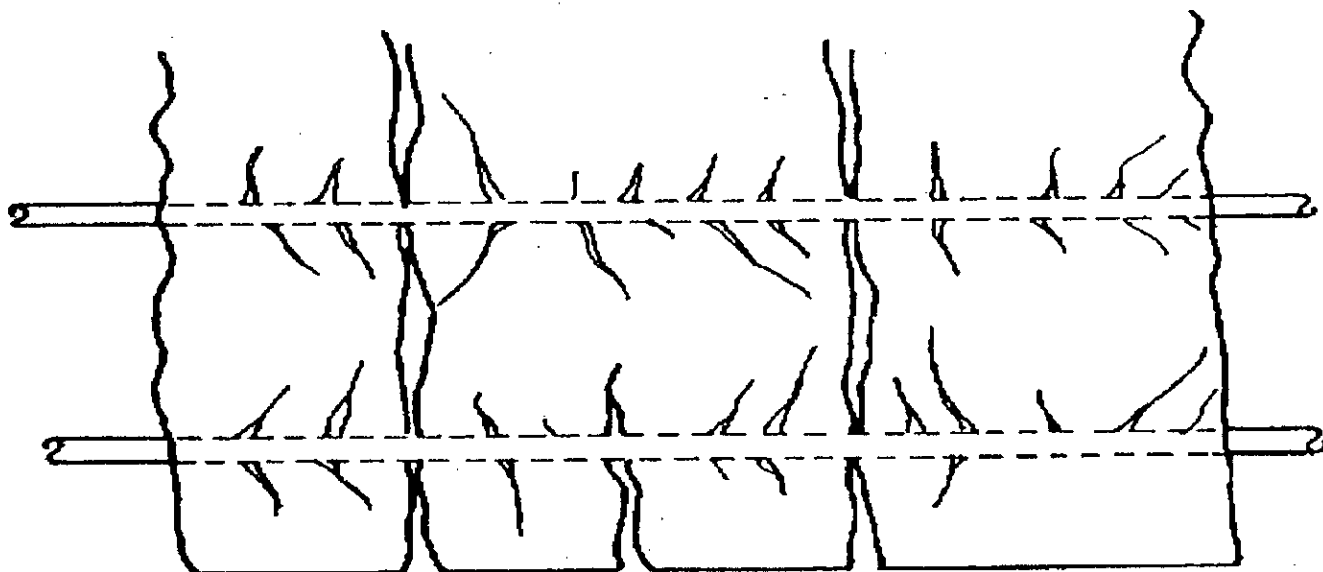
Schéma de la fissuration d'un tirant.
